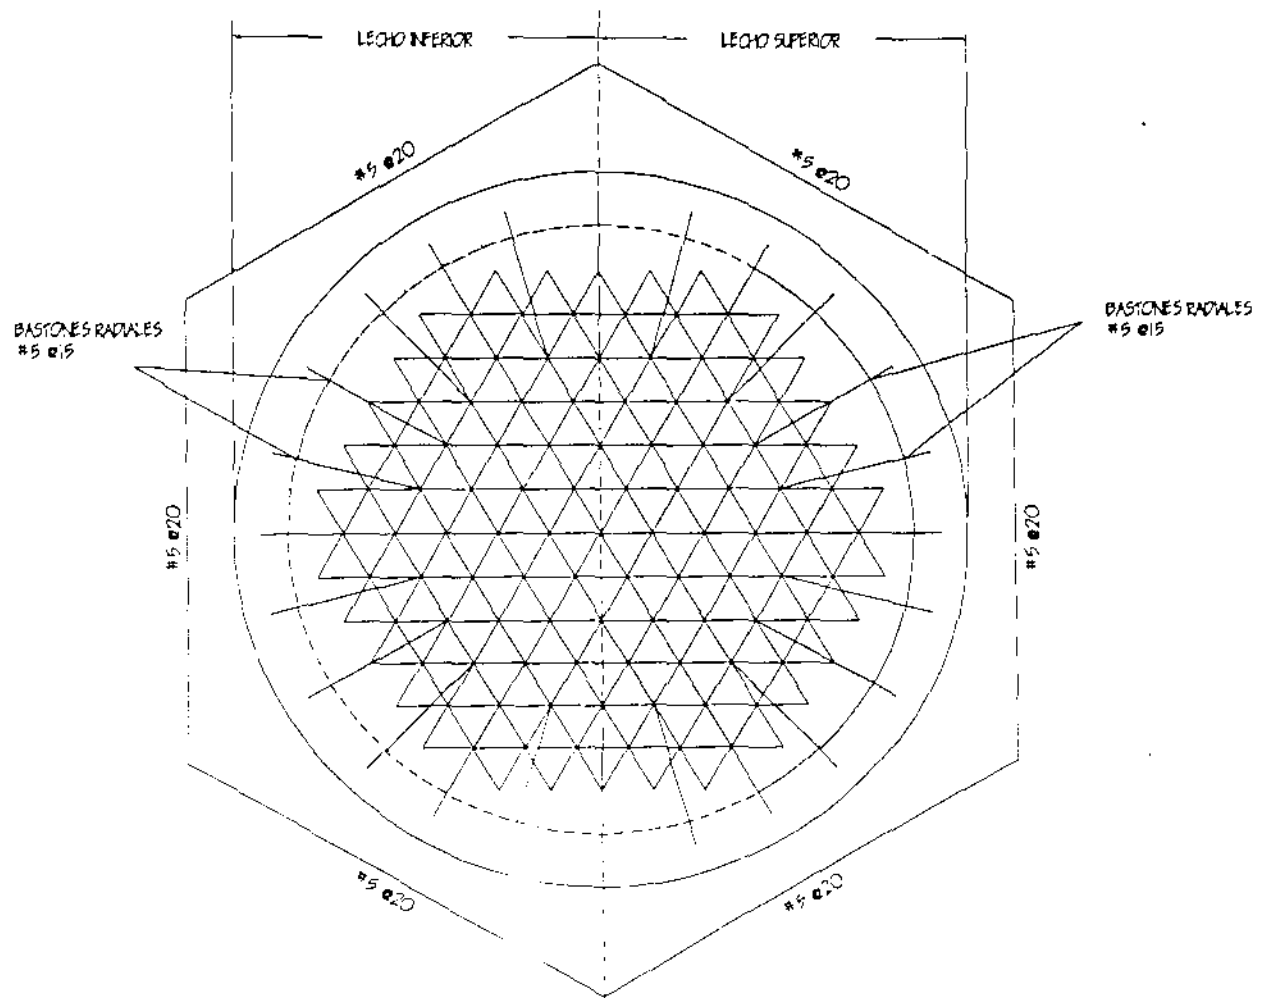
PLANTA DE ARMADO EN LOSA DE FONDO
